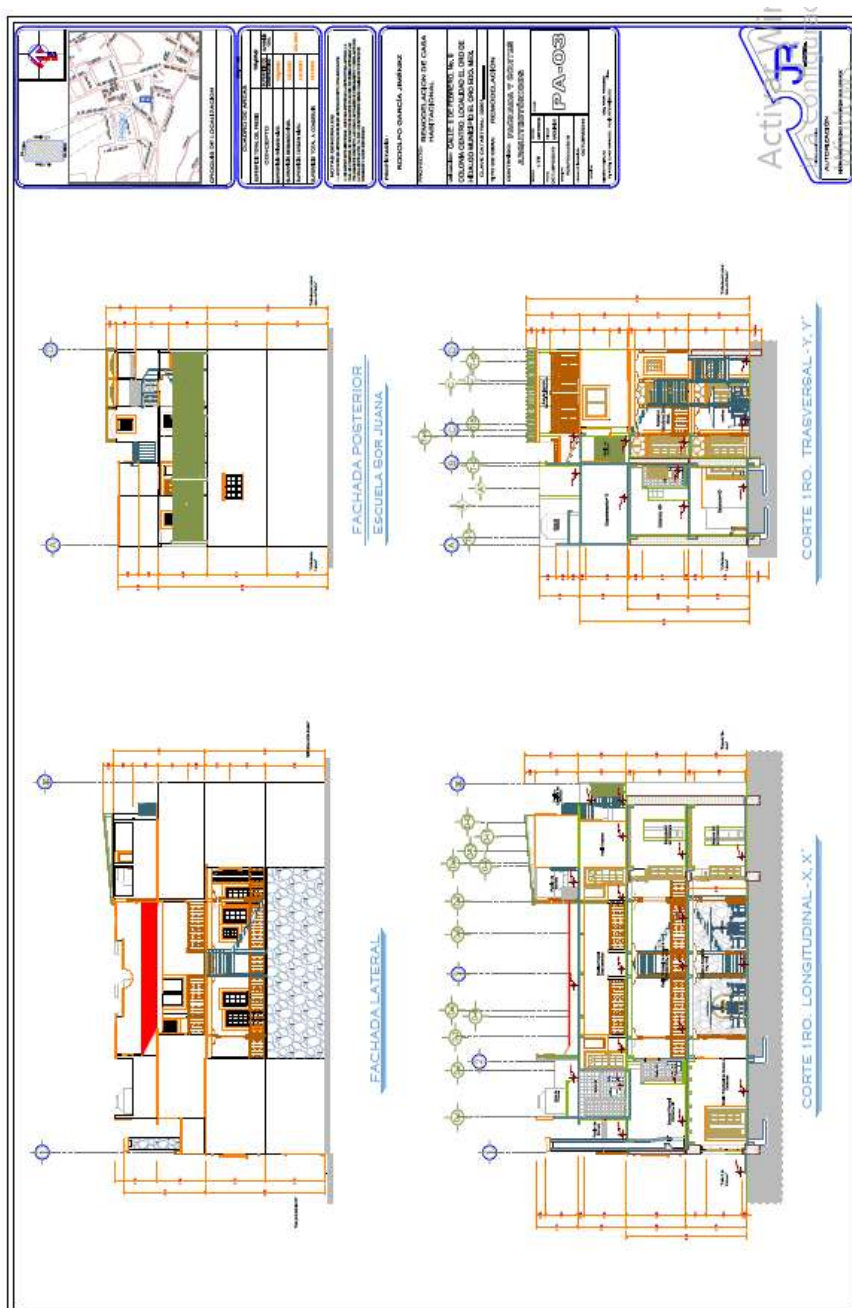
Imagen del Tercer Plano Arquitectónico, donde se representa la fachada
